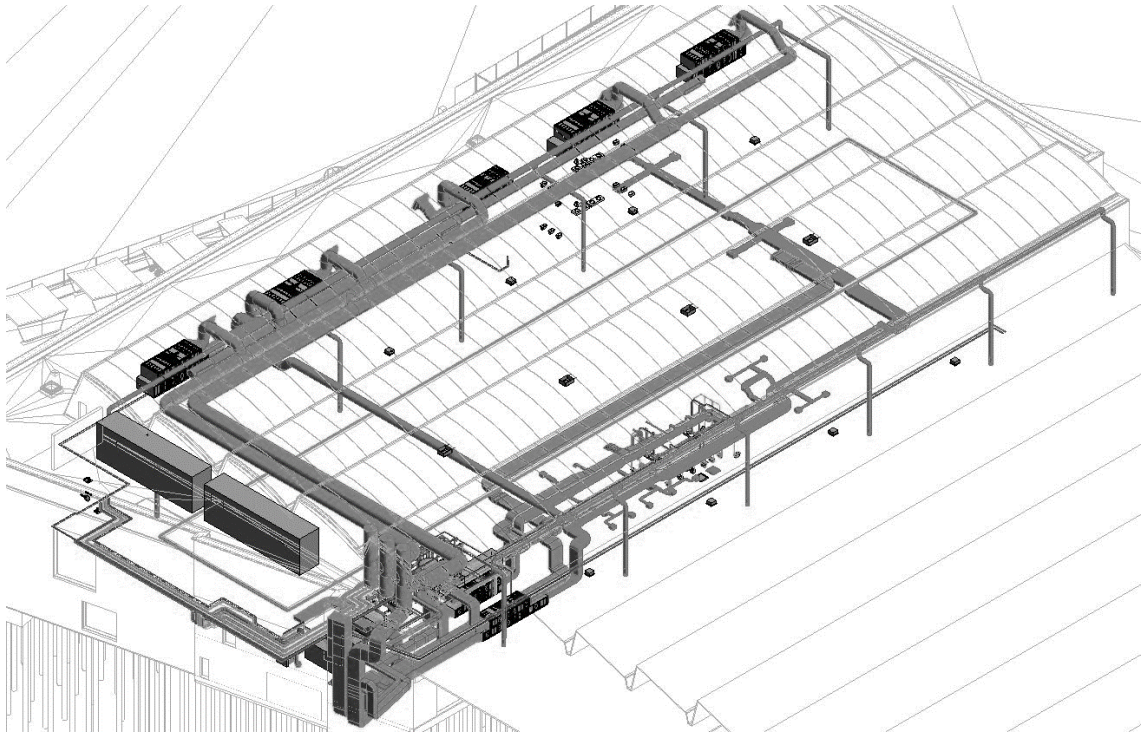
Planausschnitt Revit 3D Planung¹⁴
